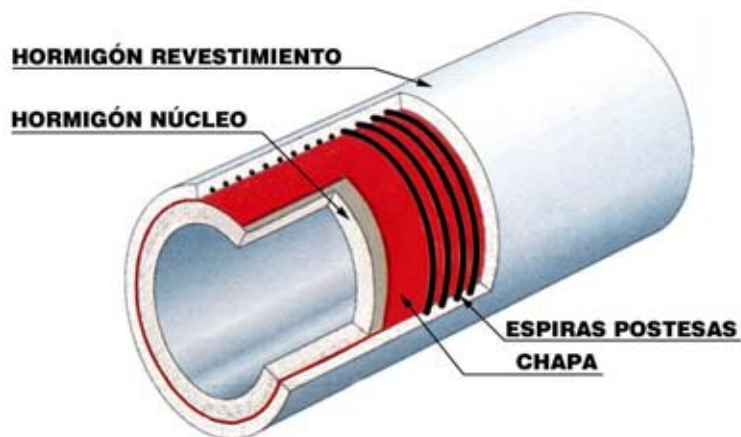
Esquema de tubo de hormigón armado con camisa de chapa
